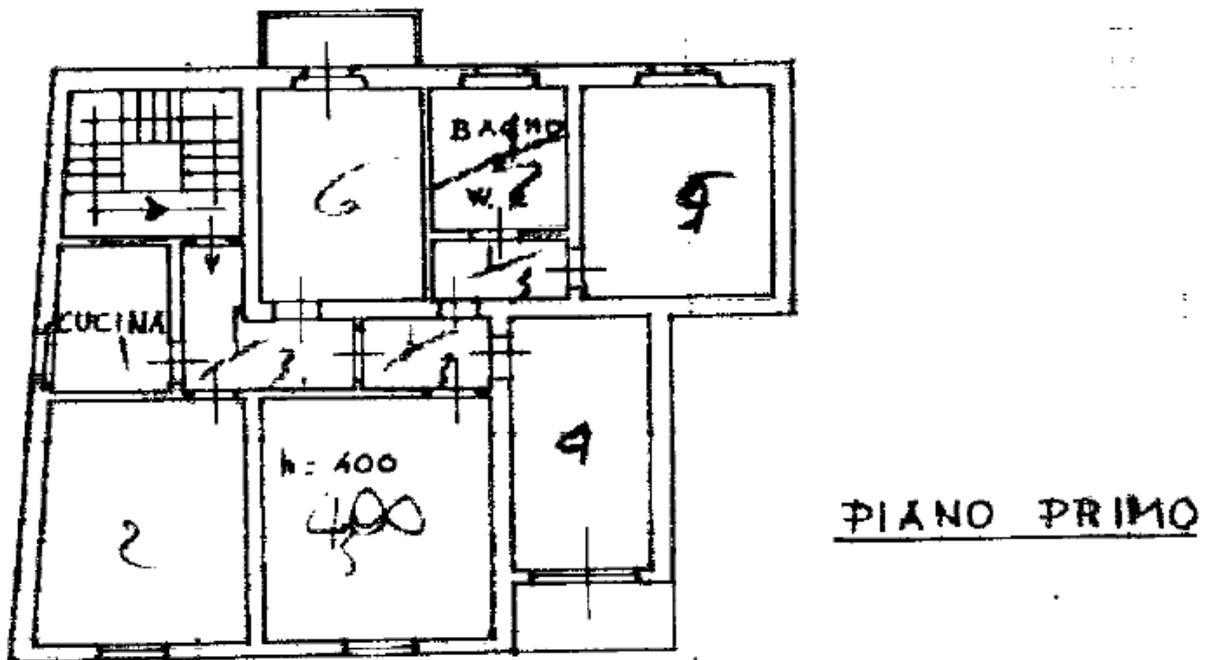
Estratto della planimetria catastale dell'appartamento oggetto di stima
